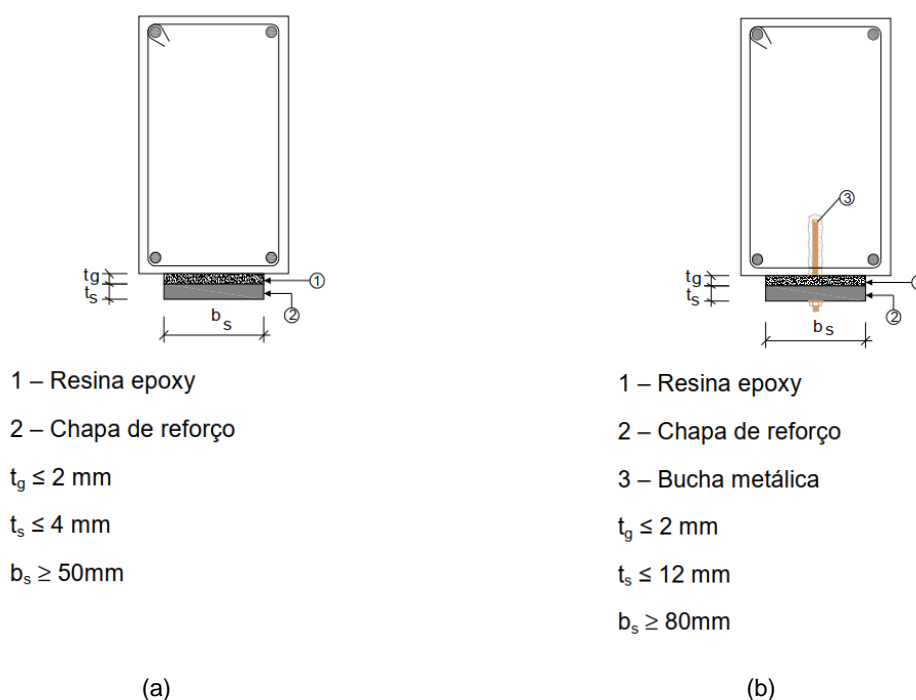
Reforço de vigas à flexão por colagem de armaduras metálicas sem bucha metálica (a) e com bucha metálica (b) – adaptado de Sousa (2008)
